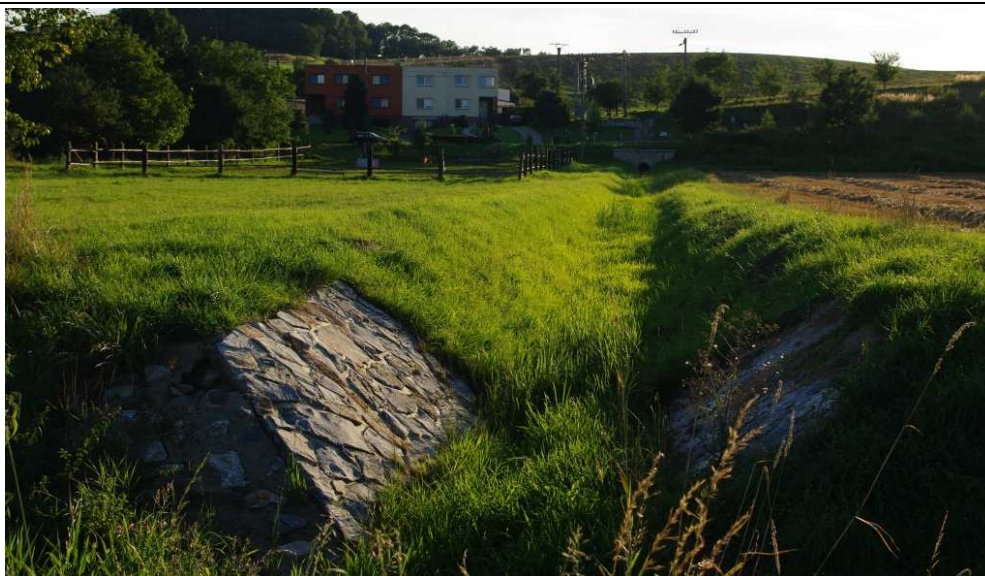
Část příkopu lemující severní okraj obce Prusinovice
